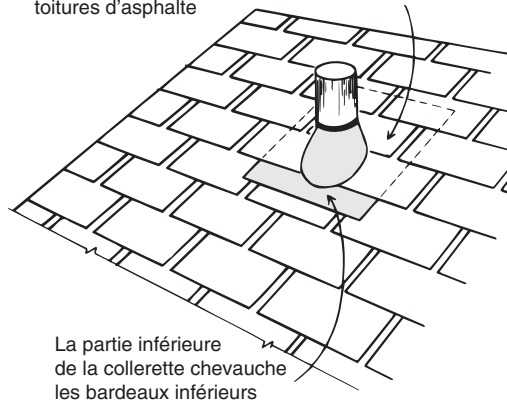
Pose de bardeaux autour d'une collerette.
